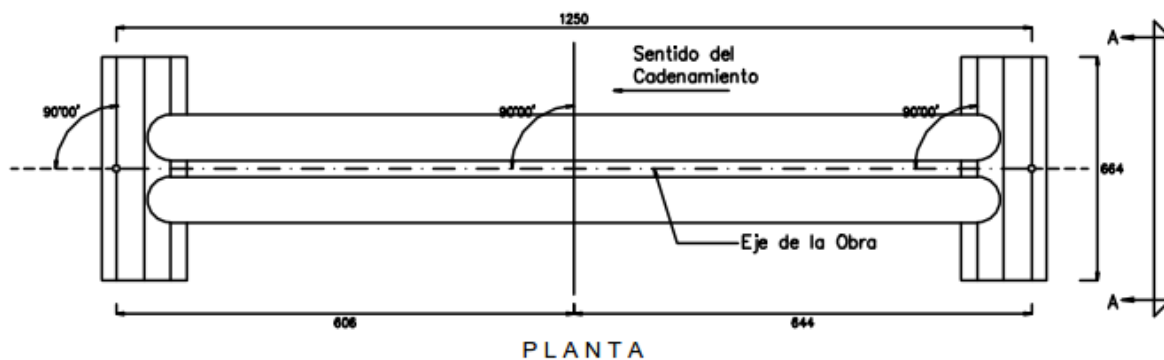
Planta de la obra de drenaje proyectadas con dos líneas de tubería de concreto de 1.20 mts de diámetro.
